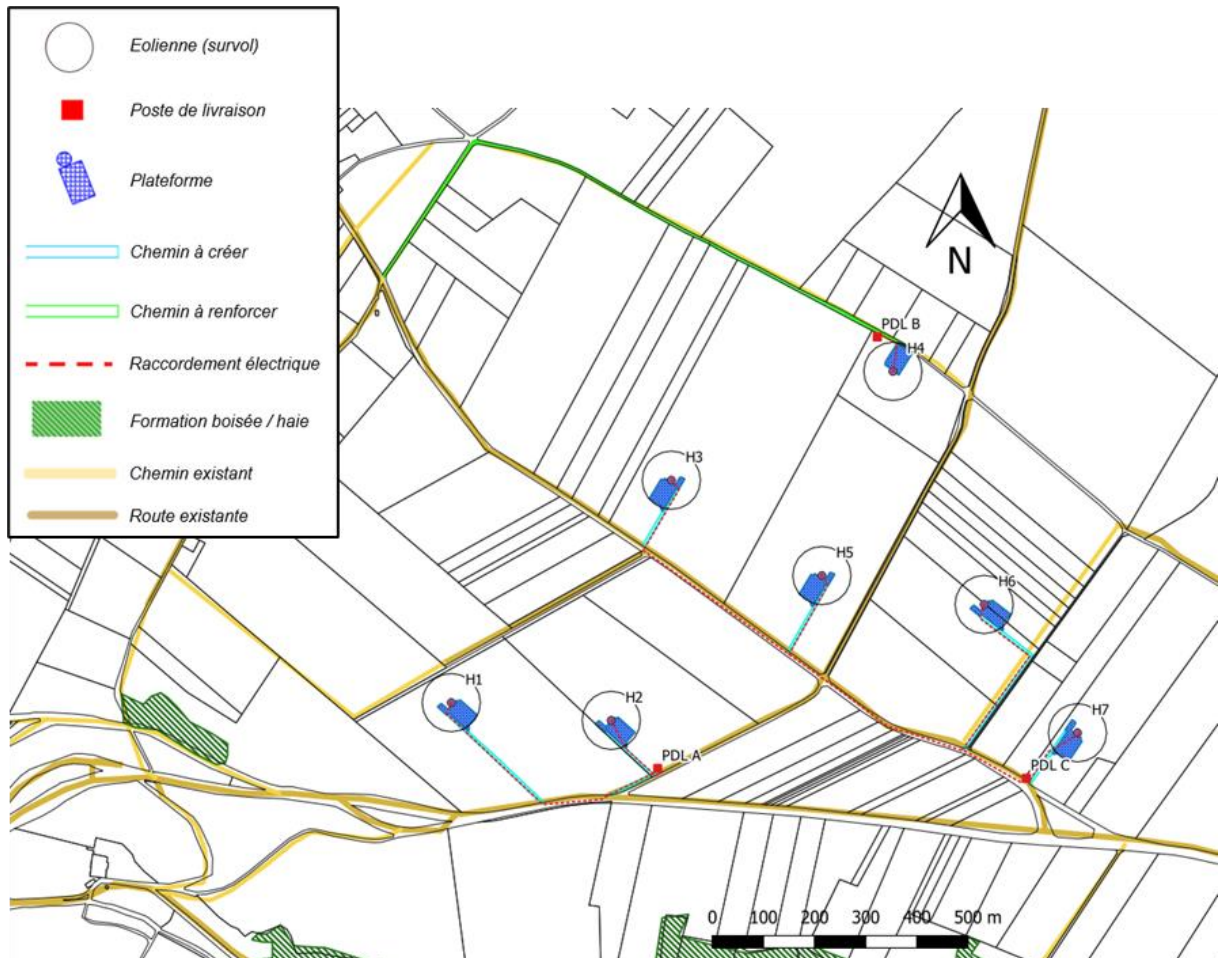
PLAN D'IMPLANTATION DES EOLIENNES AVEC CHEMINS D'ACCES ET POSTES DE LIVRAISON – PARC DE LA HAUTE-COUTURE
